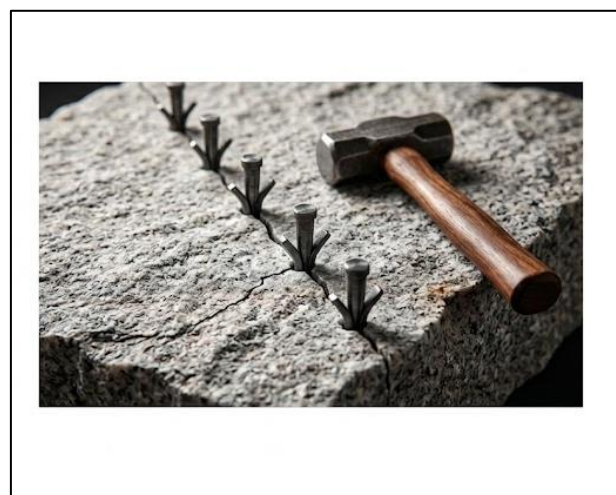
Fendage de la pierre par la technique de plug-and-plumes
